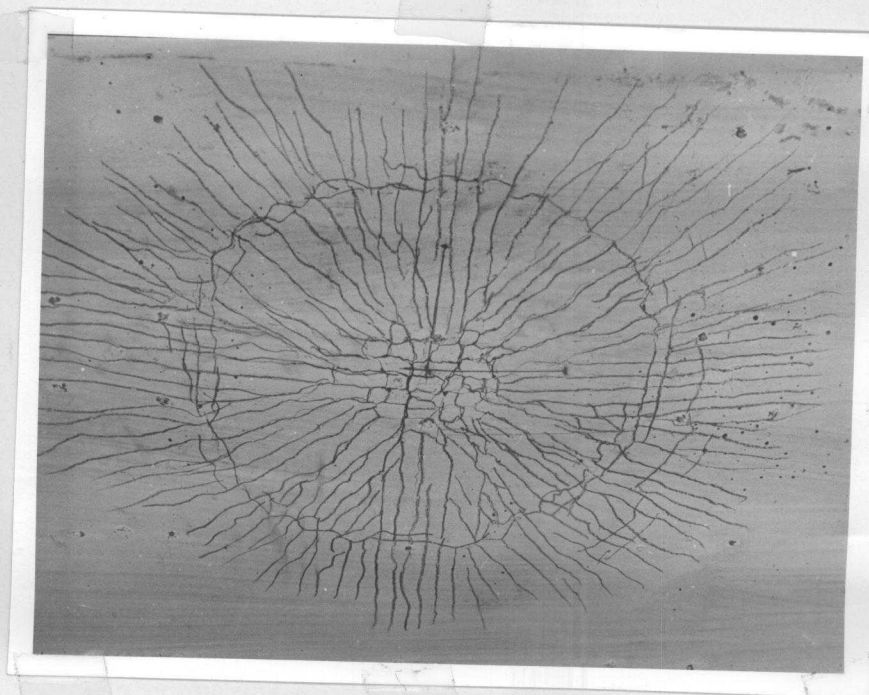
Estado de fissuração da face inferior de uma das lajes, por ocasião da ruptura.
